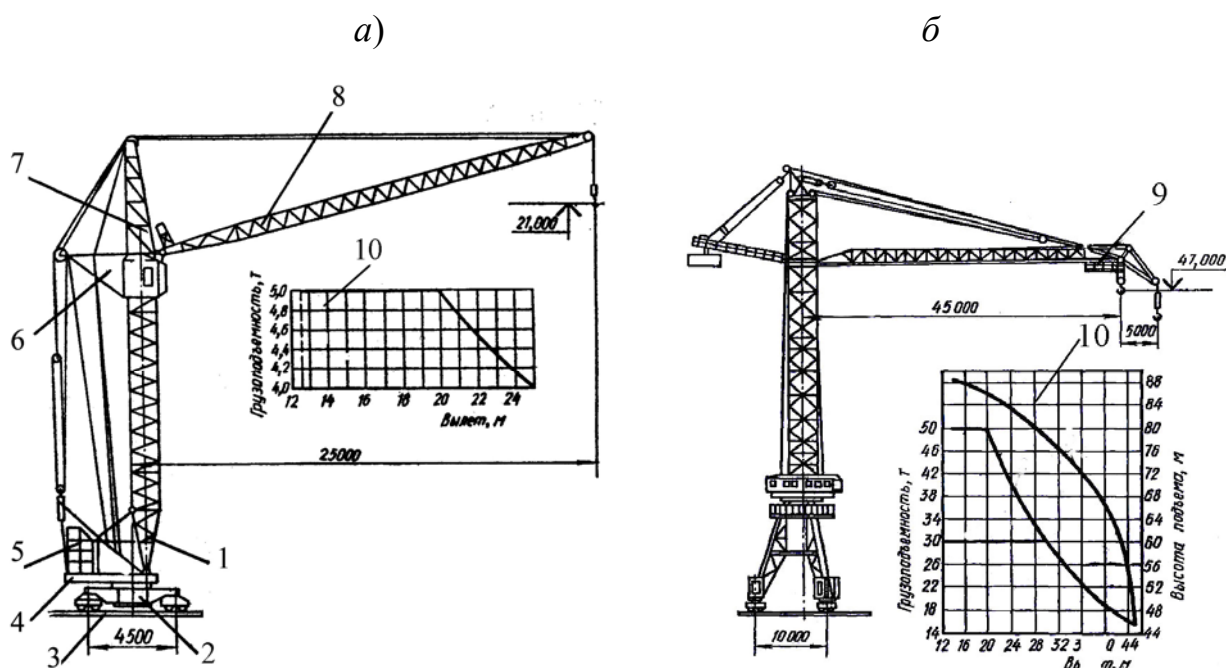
Башенные краны: а – с поворотной платформой: 1 – башня; 2 – ходовое устройство; 3 – рельсовый путь; 4 – поворотная платформа; 5 – балласт (контргруз); 6 – стрела контргруза; 7 – оголовок, 8 – грузовая стрела; б – с поворотной башней: 9 – грузовая тележка; 10 – грузовые и высотные характеристики кранов
